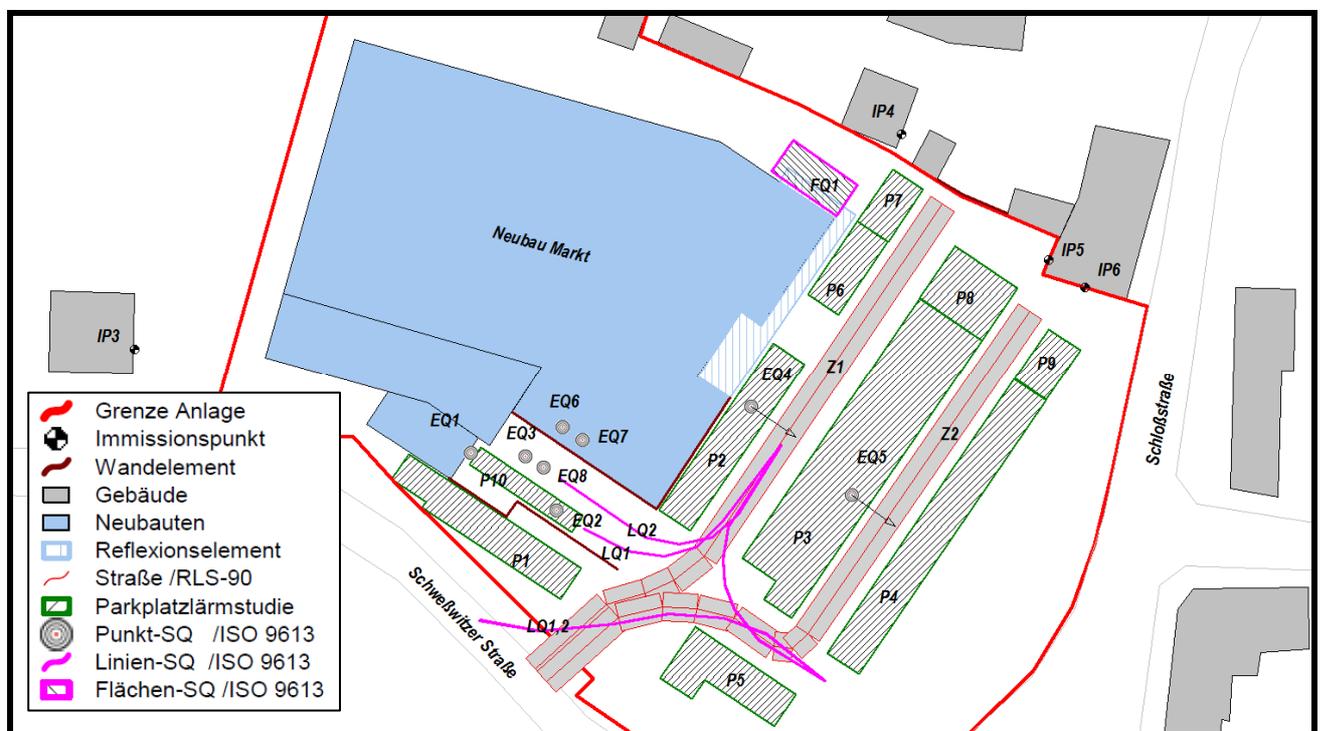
Lageplan Schallquellen und nächstgelegene Immissionsbereiche gemäß Planstand /1/
